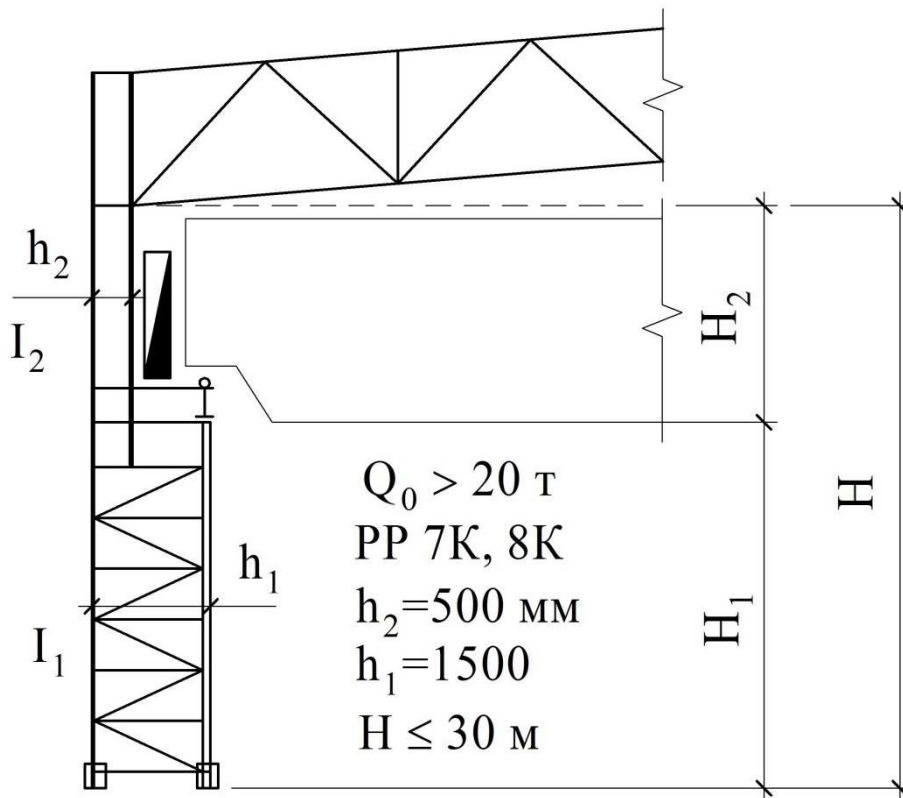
, б – Конструктивная схема однопролетной поперечной рамы с проходом между внутренней гранью колонны и габаритом крана
